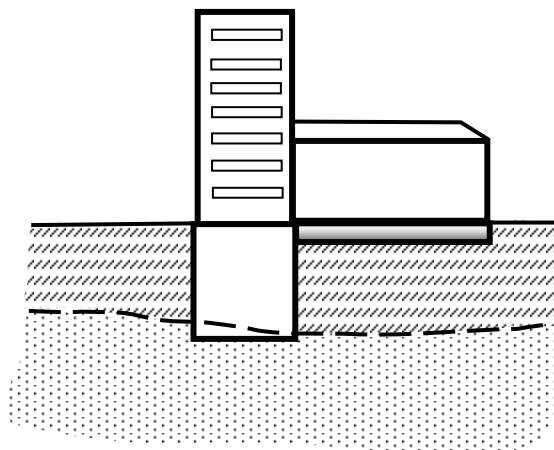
Неравномерные осадки уплотнения при опирании фундаментов сооружения на разные грунты
